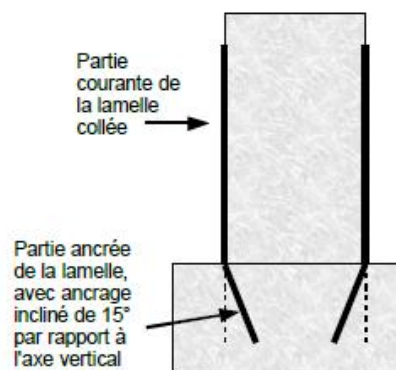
Schéma de principe de mise en place des lamelles ancrées sur un poteau.
